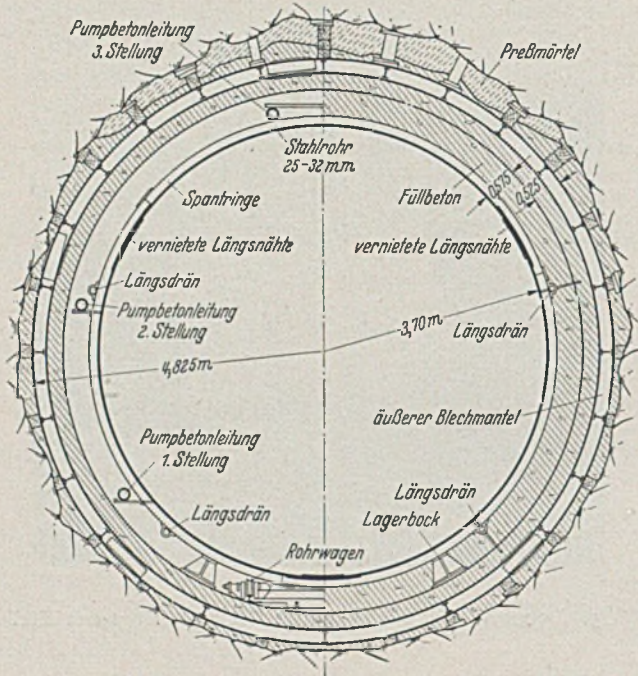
Querschnitt der Druckrohrleitung des Fort-Peck-Dammes, links vor Einbringen des Betons, rechts fertiger Ausbau.
